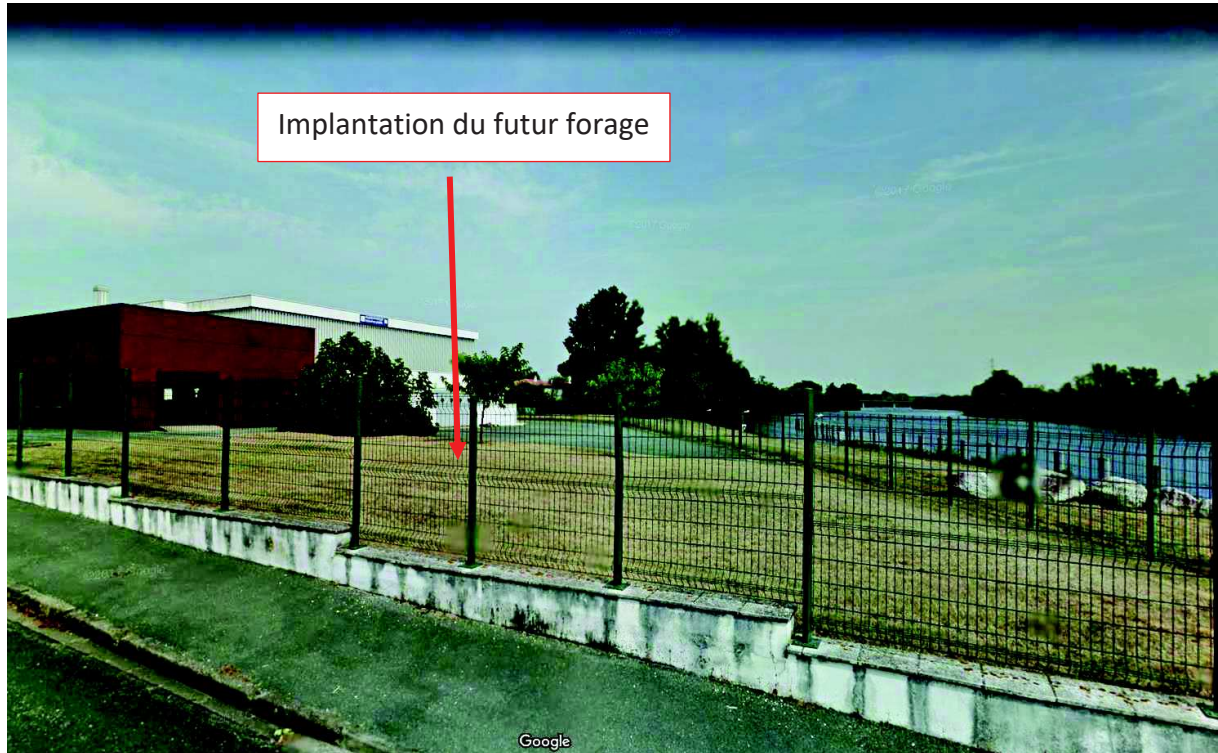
Photo du site d'implantation dans l'enceinte de l'usine (24/10/18)
